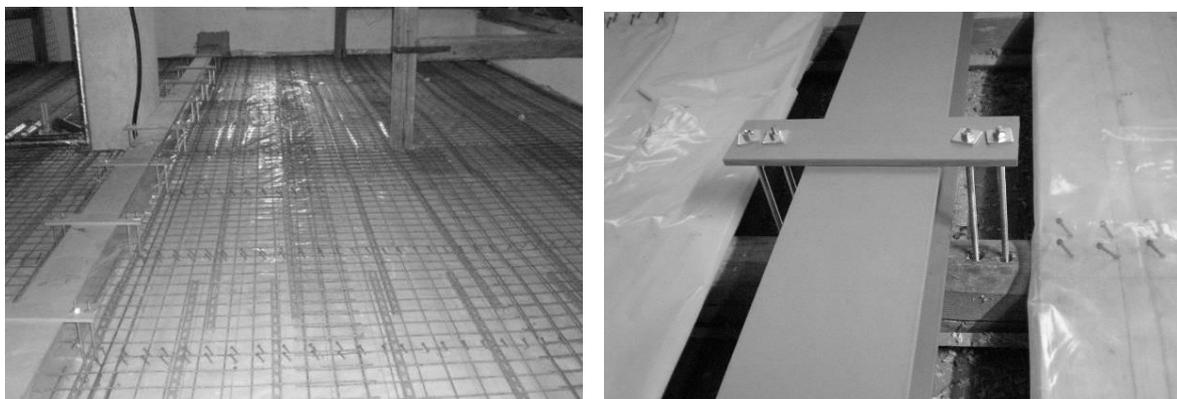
HBV-Decke mit Deckenaufhängung vor dem Betonieren (links), Aufhängung der Deckenbalken mit dem SIHGA IdeFix
